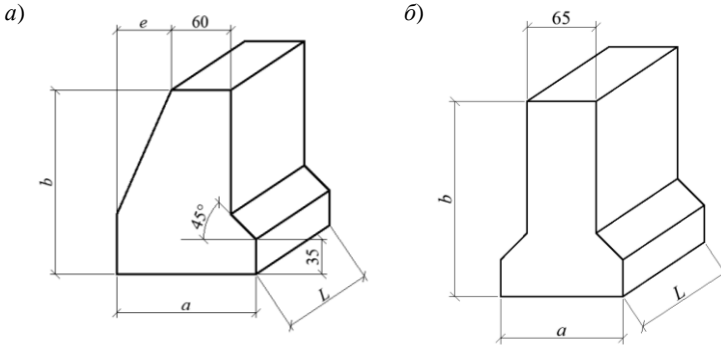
Массивные стеновые блоки (стенки) бетонных водопропускных труб:
